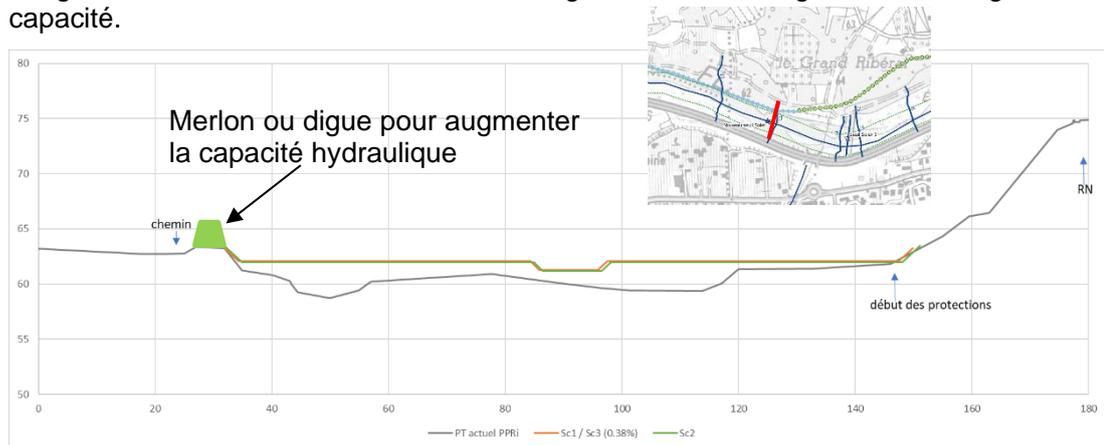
Implantation des lits étagés sur le secteur du Soler 3 où la section hydraulique est réduite
